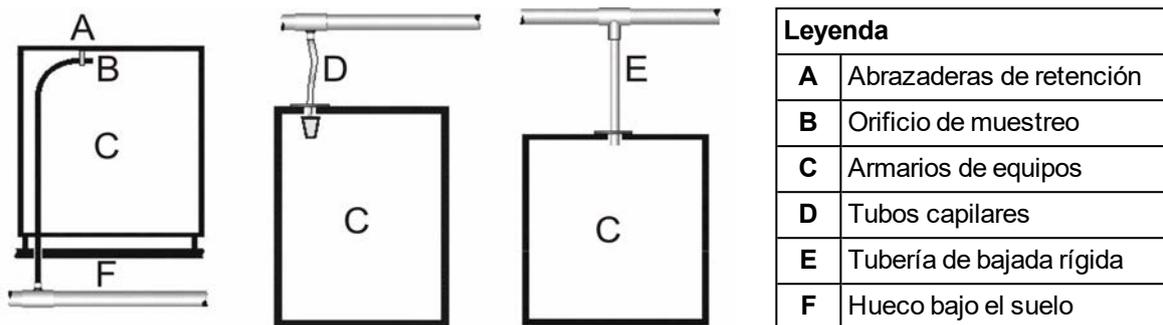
Muestreo dentro de armario que utiliza tubos capilares y tuberías de bajada
